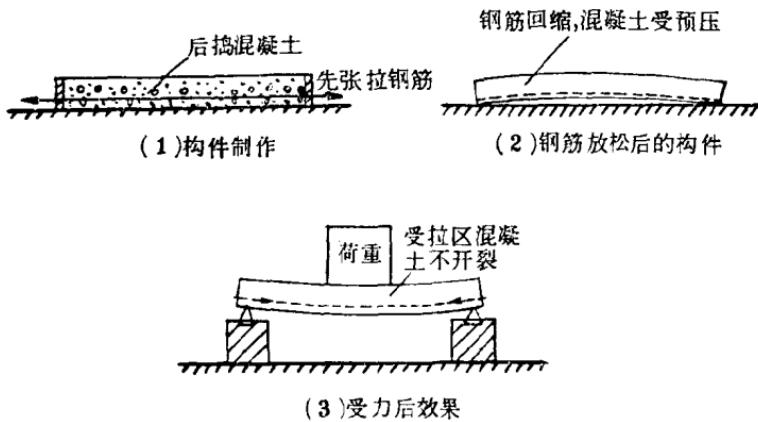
预应力混凝土梁、板中钢筋与混凝土的内在联系示意图
